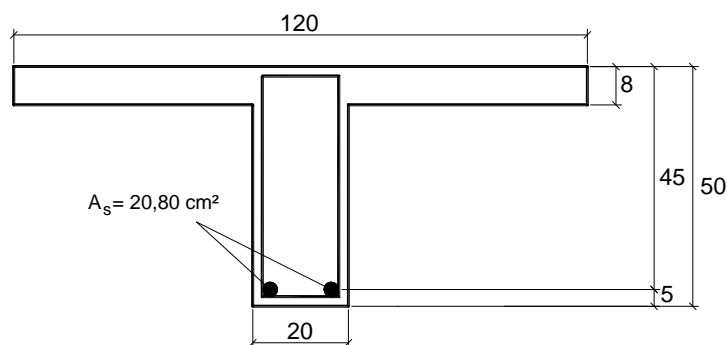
Seção transversal com dimensões (cm) e área de armadura de tração.
